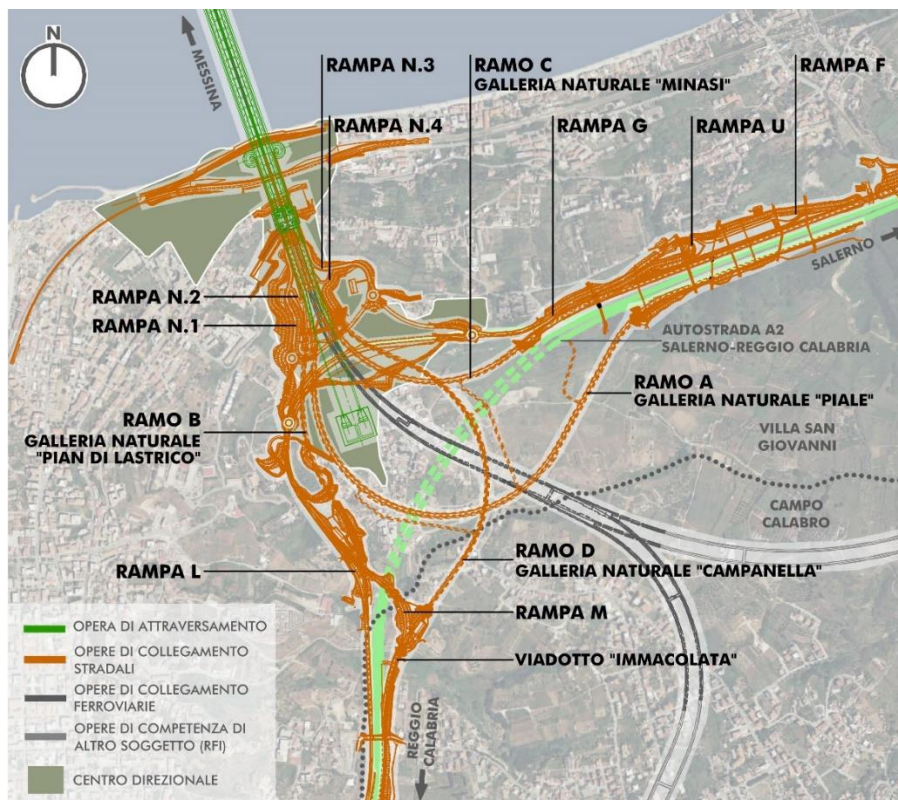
Stralcio planimetrico con indicazione dei rami, delle rampe e delle principali opere d'arte di progetto costituenti i collegamenti stradali sul versante Calabria
